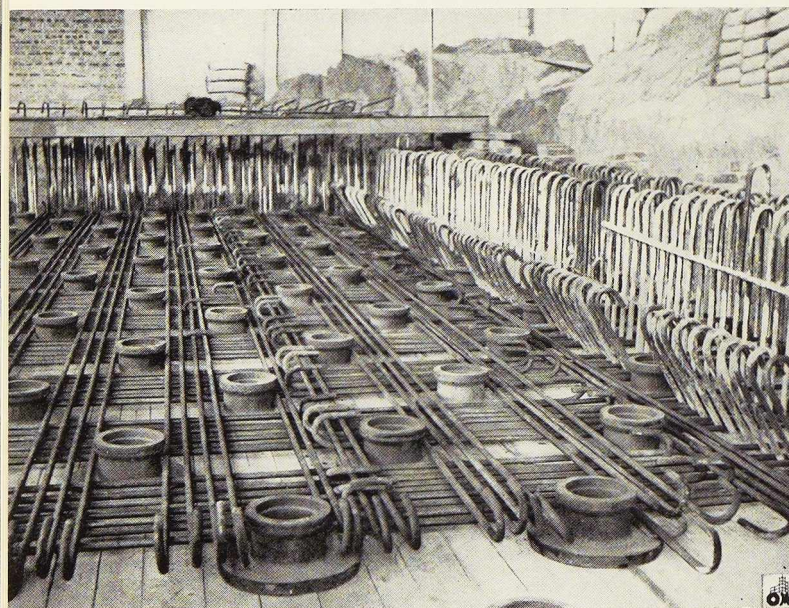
Montre les armatures du bas de la dalle et les sortes de douilles réservant les trous de passage pour boulons d'ancrage.
